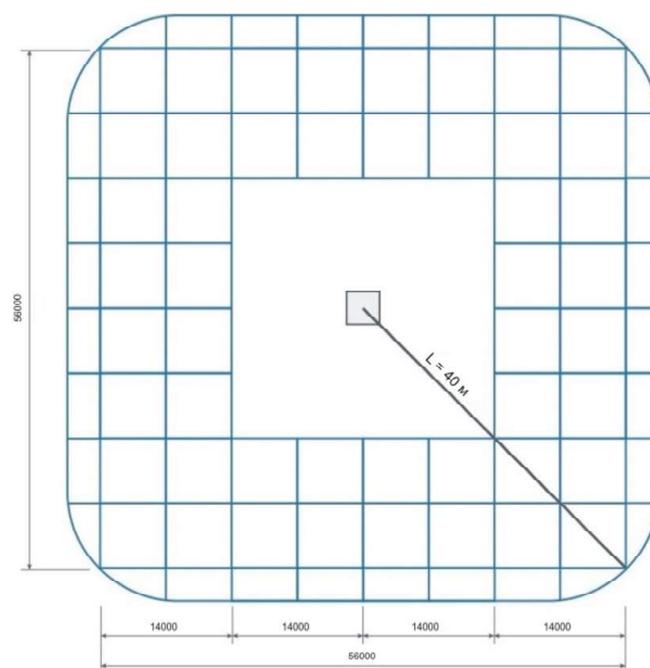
План рядового этажа жилого дома для проживания в жестких погодных условиях.
